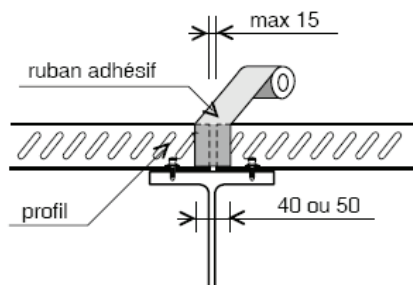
Exemple de traitement d'étanchéité au recouvrement entre bacs, au droit de l'appui
